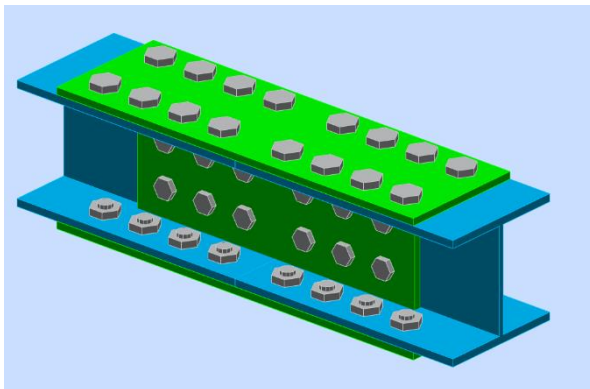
Représentations de l'assemblage Poutre-Poutre (Eclissage)
